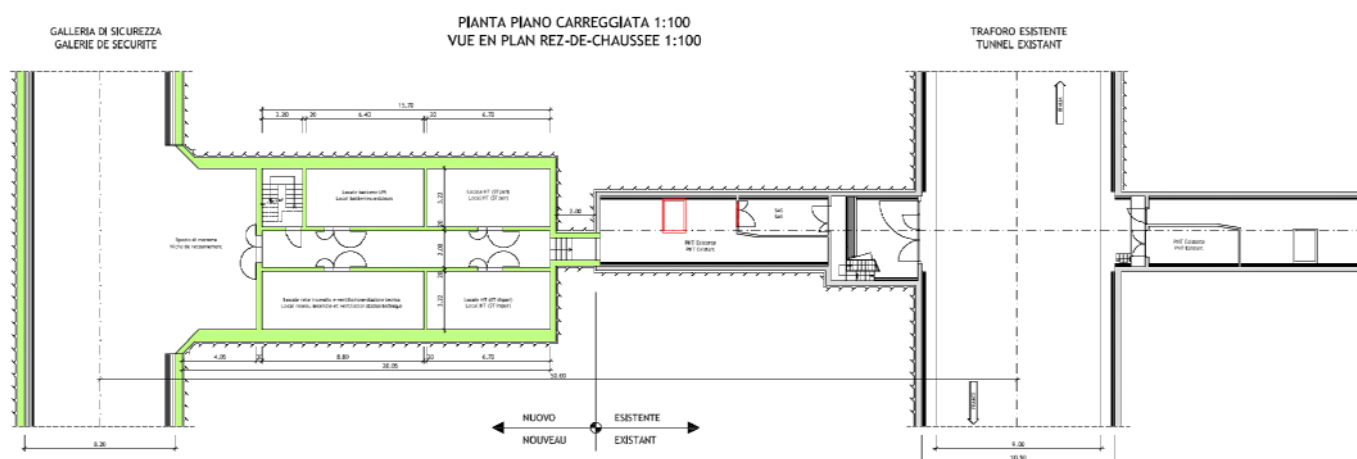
Vue en plan des ST standards et PHT, rez-de-chaussée.
